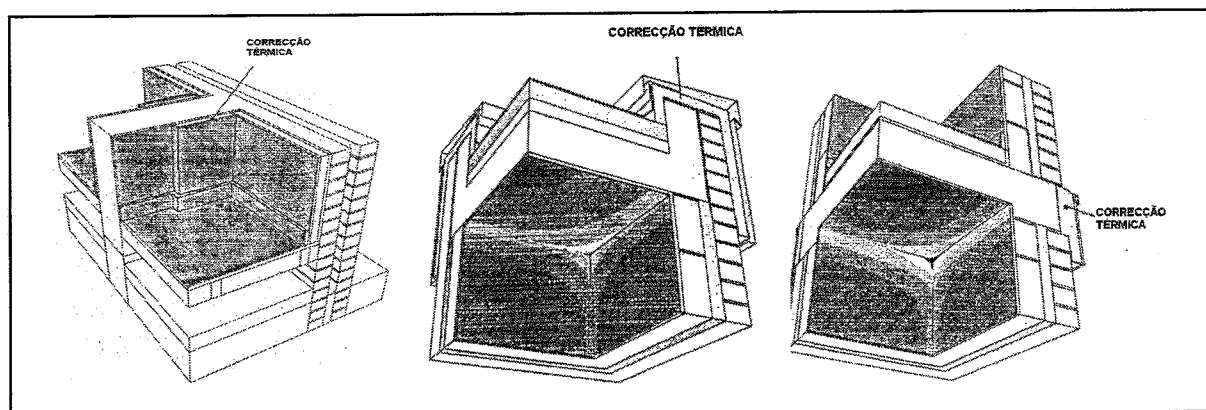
Propostas de reabilitação térmica para diversas zonas de ponte térmica [10]
